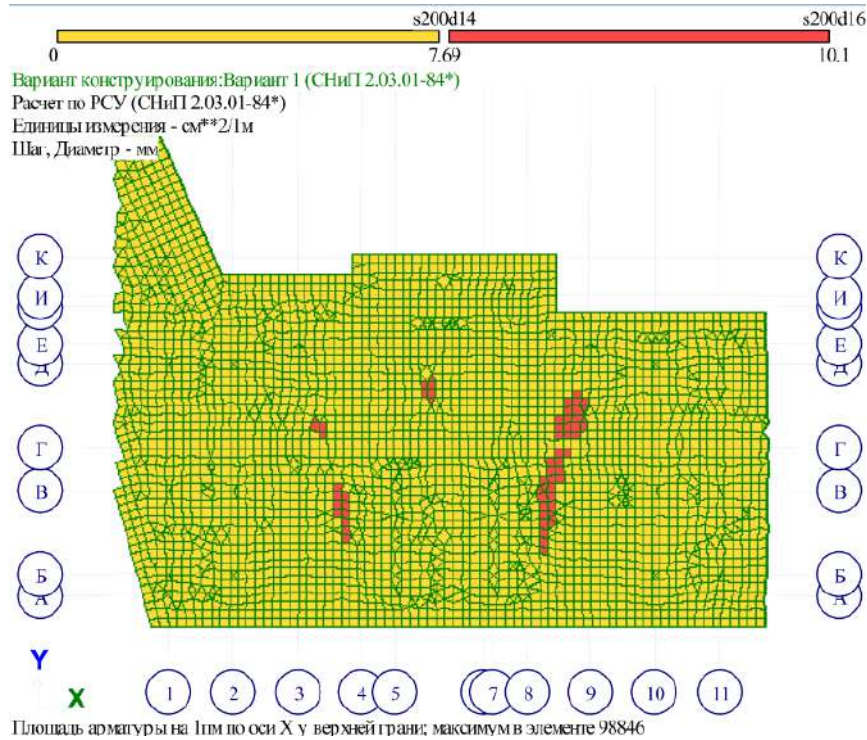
Площадь арматуры на 1 п.м. по оси X у верхней грани
